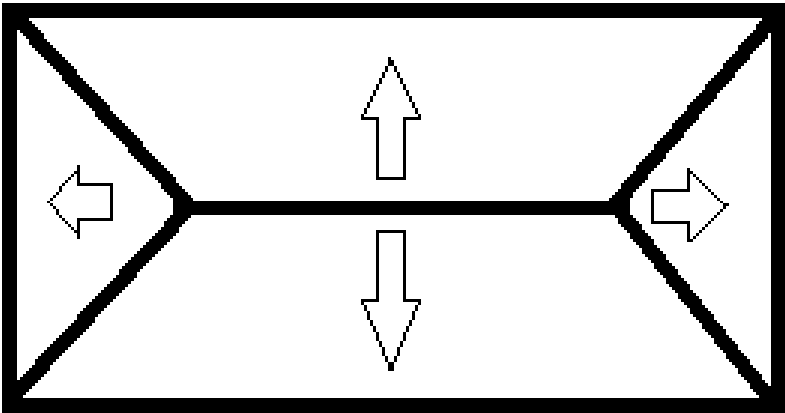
Ytavrinning med tvärfall på konstgräsplan.
